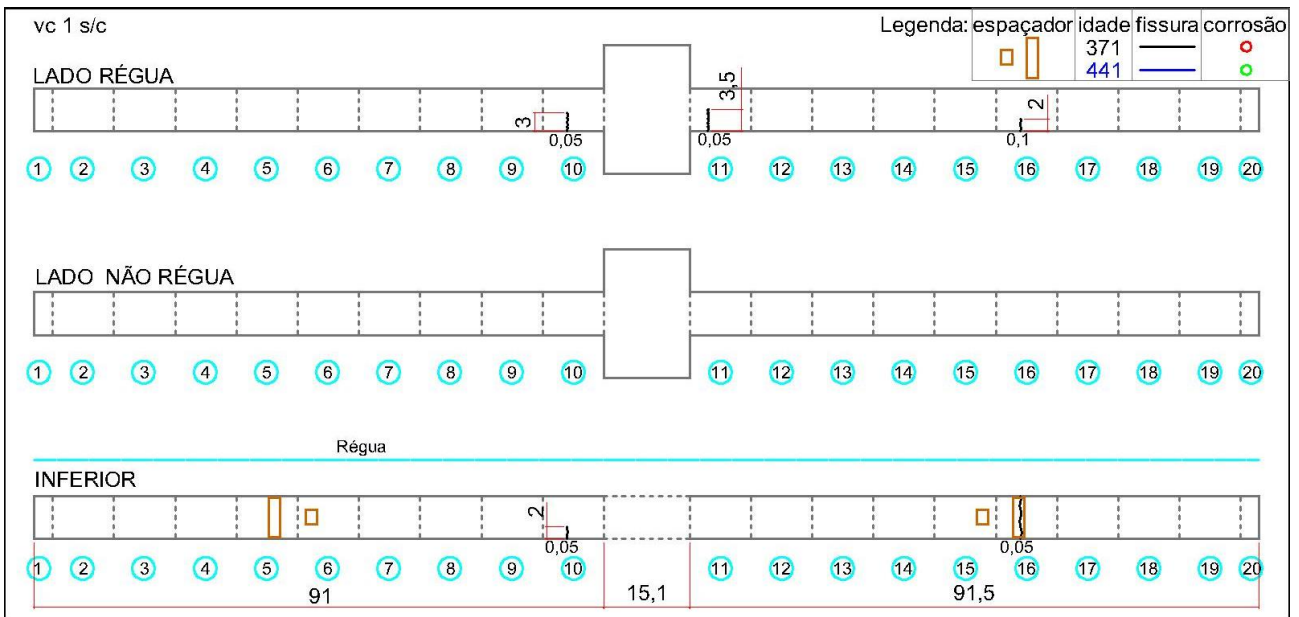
Mapa das fissuras na viga vc 1 s/c
